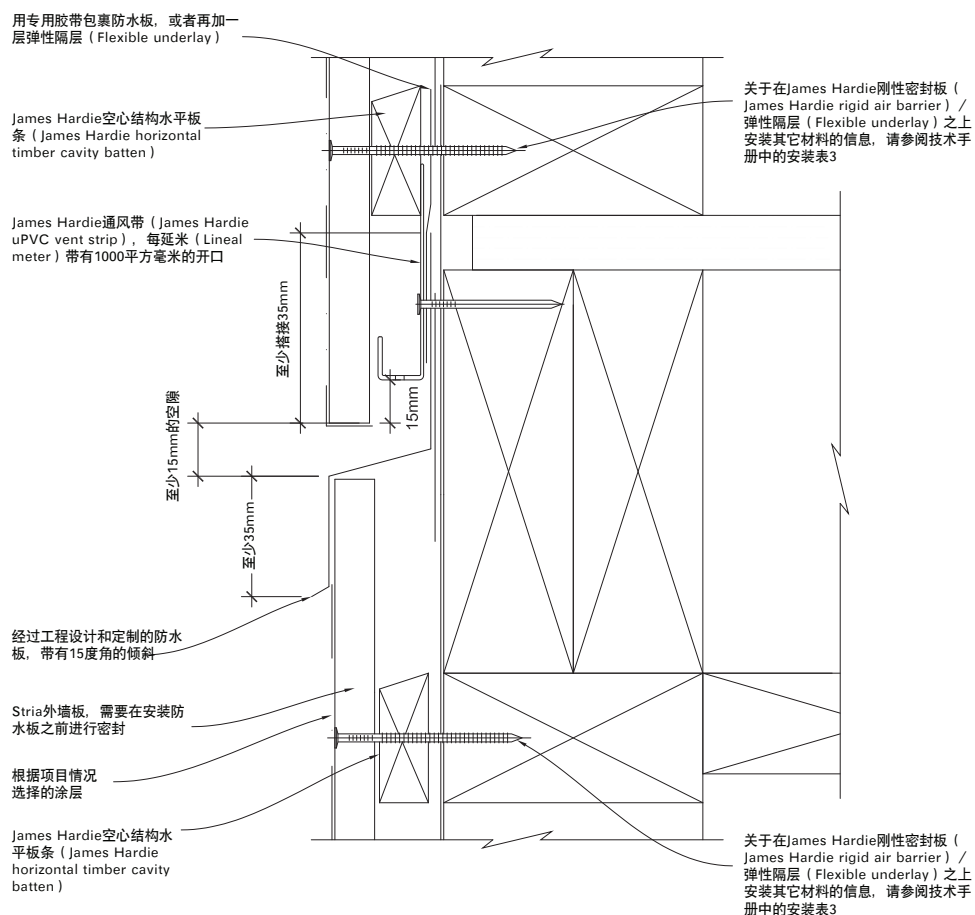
位于一层的排水槽防水连接件(Drained flashing joint)
